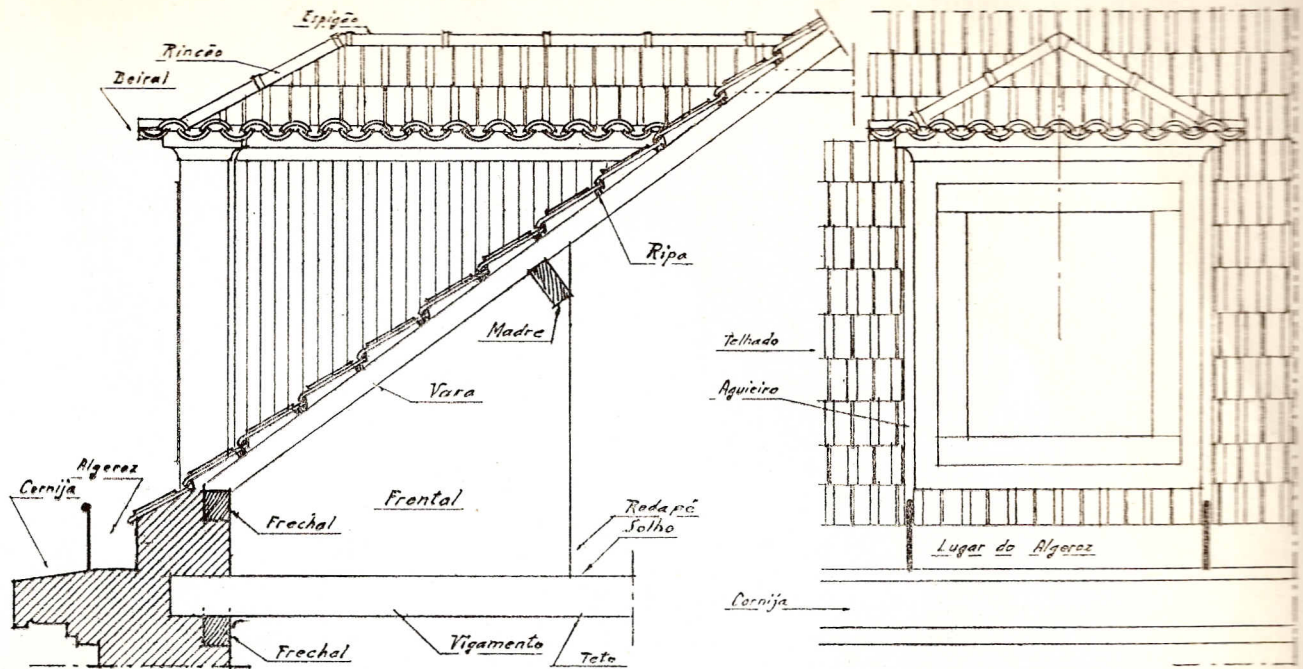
TRAPEIRA CONSTRUÍDA DE ALVENARIA
